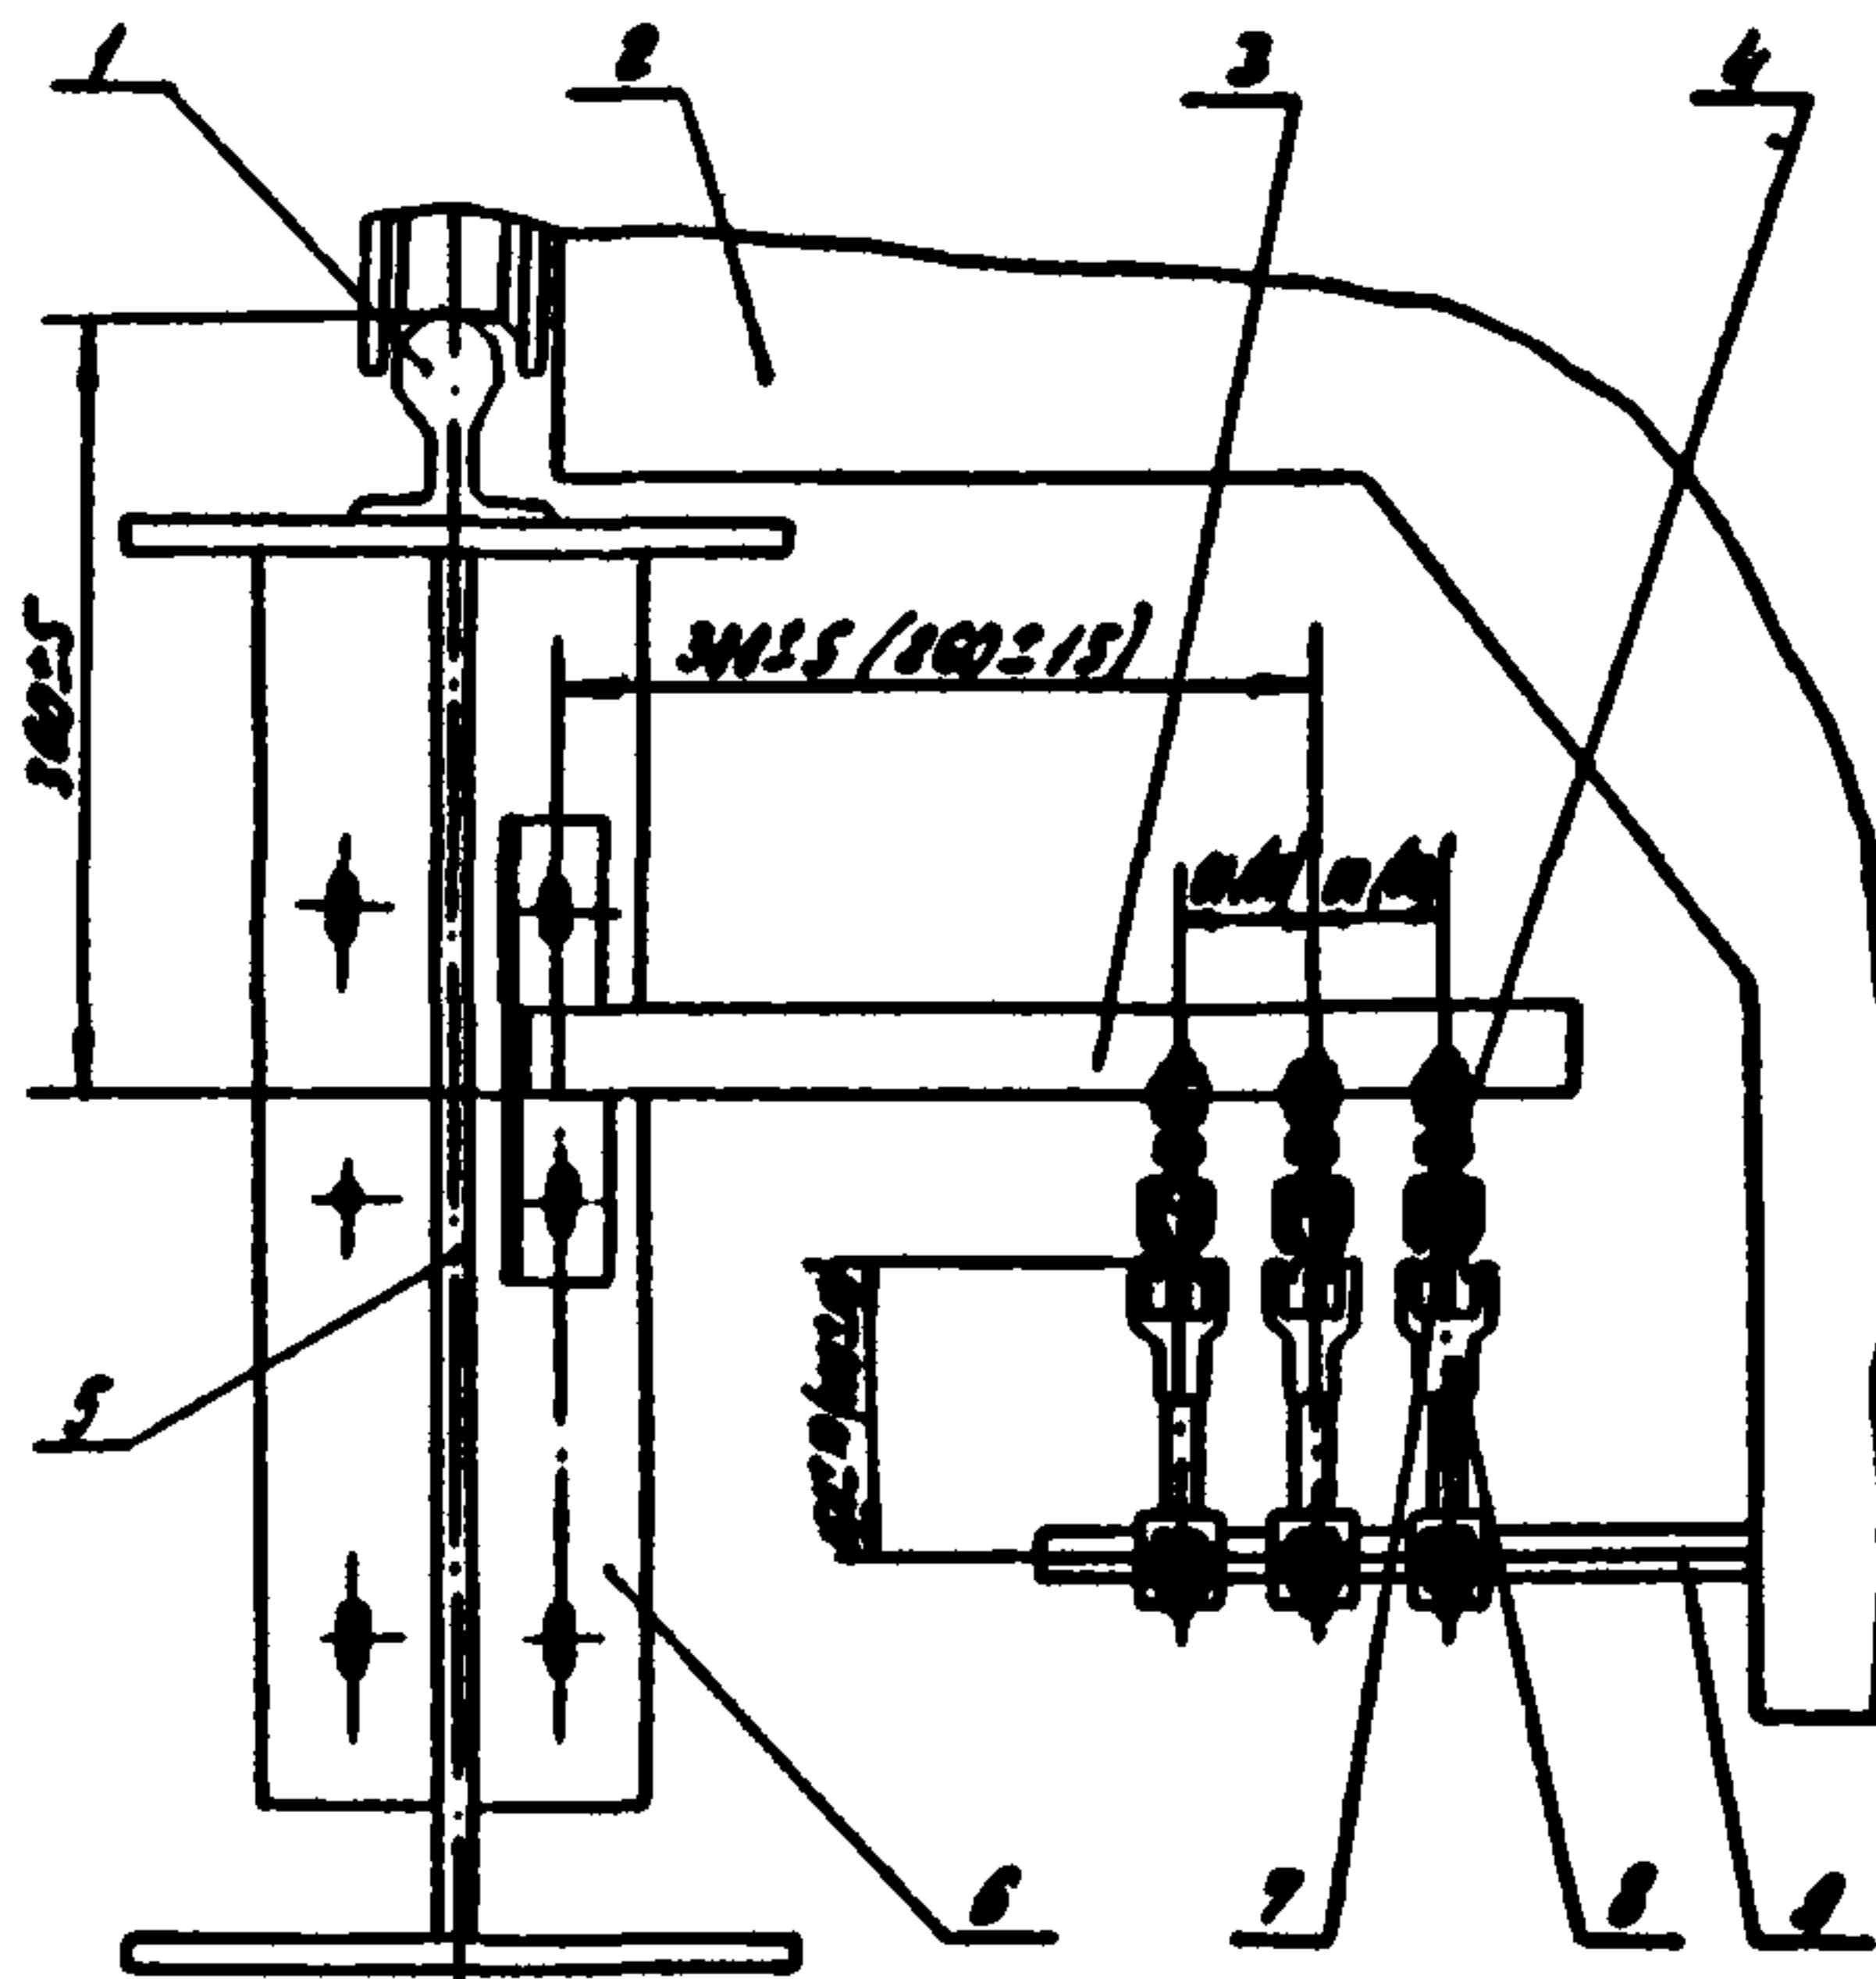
Установка кронштейнов на металлических подкрановых балках, крепление траверсы к корпусу крана (размеры в скобках для ШМТ-А 400 А): 1 - рельс; 2 - корпус крана; 3 - кронштейн; 4 - троллеедержатель; 5 - ребро жесткости; 6 - подкрановая балка; 7 - тrolley; 8 - токосъемник; 9 - траверса.
